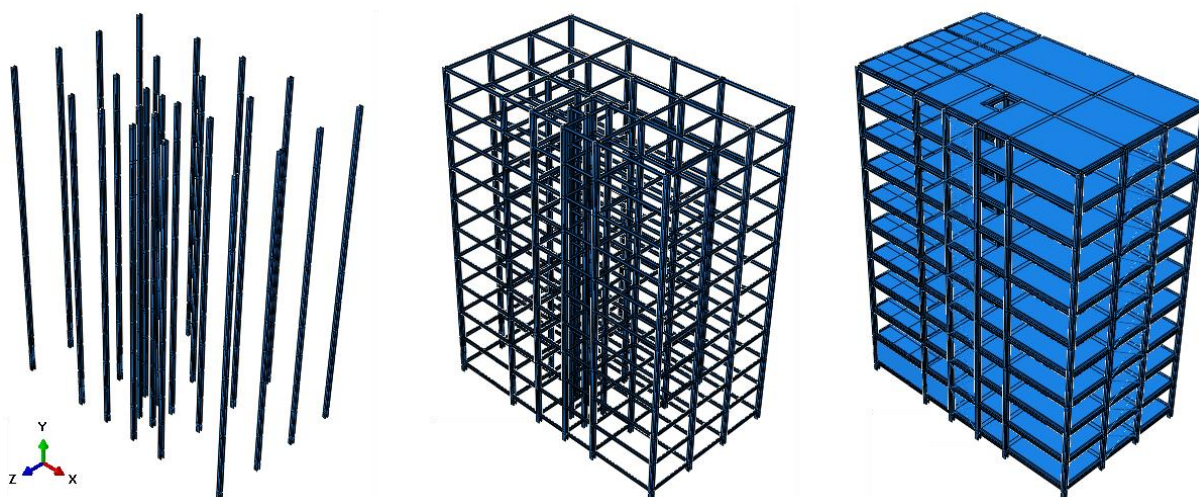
Construção do modelo estrutural no módulo Assembly
